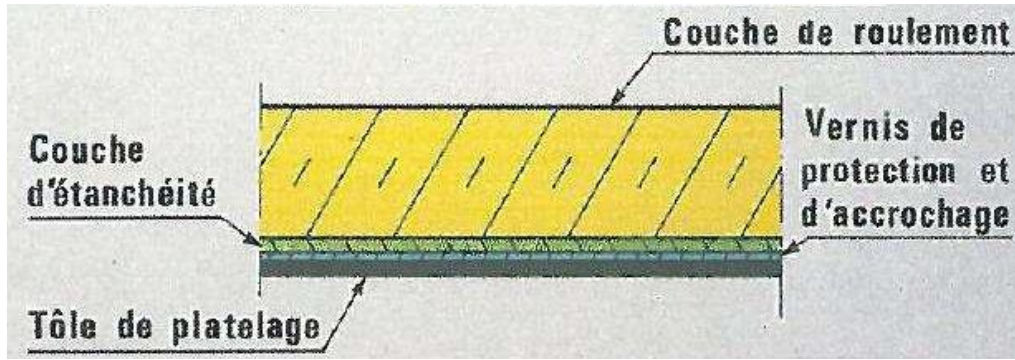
Revêtement épais multicouche de la dalle orthotrope
